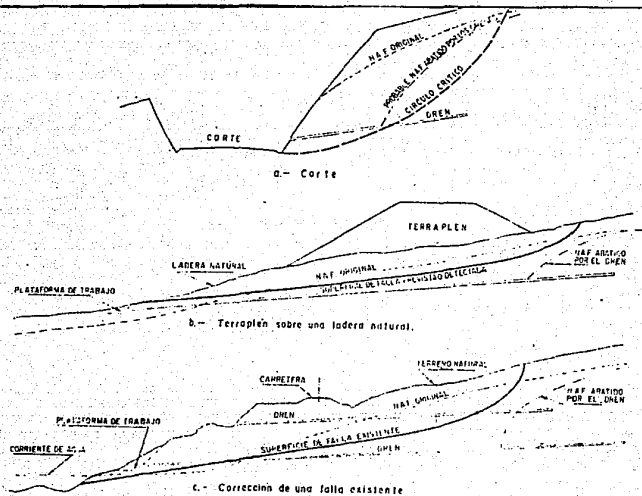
Casos de la disposición de drenes transversales de penetración.
